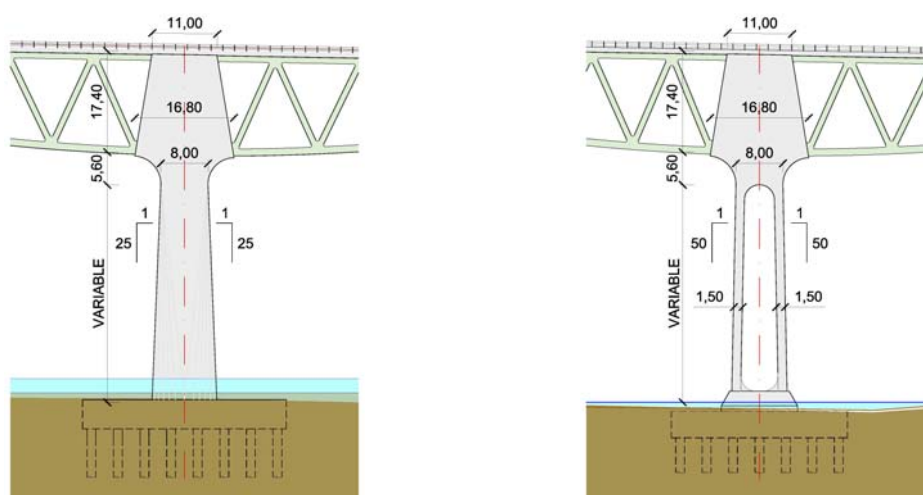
y 4b. Vista de las pilas centrales (P-6 y P-7) y laterales (P-5 y P-8)
